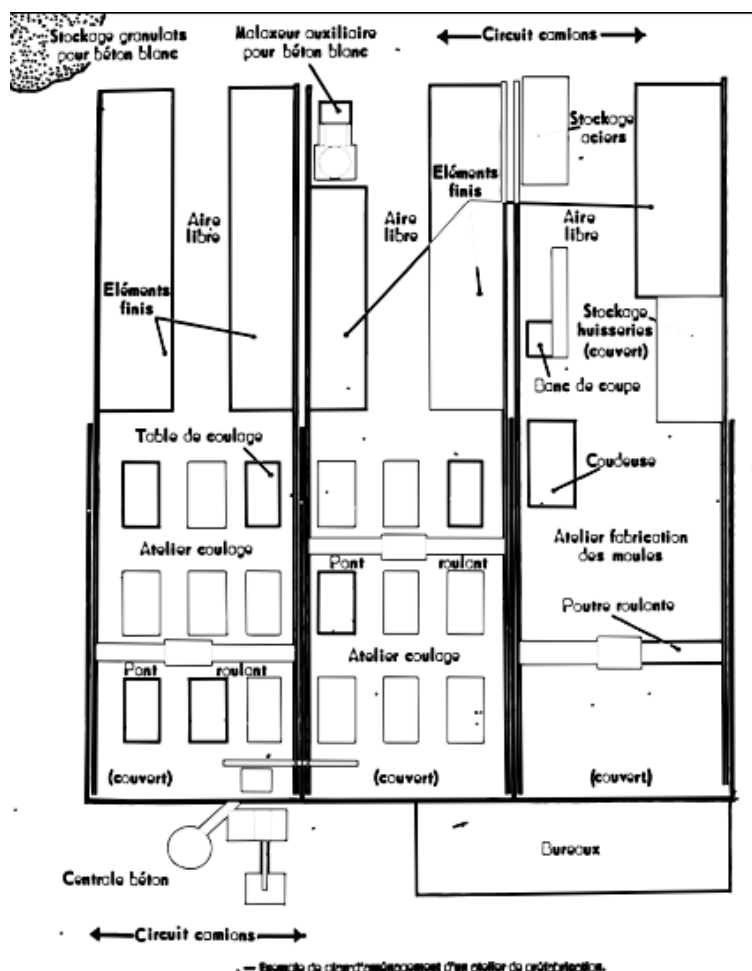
Exemple de plan d'aménagement d'un atelier de préfabrication (Neufert)
